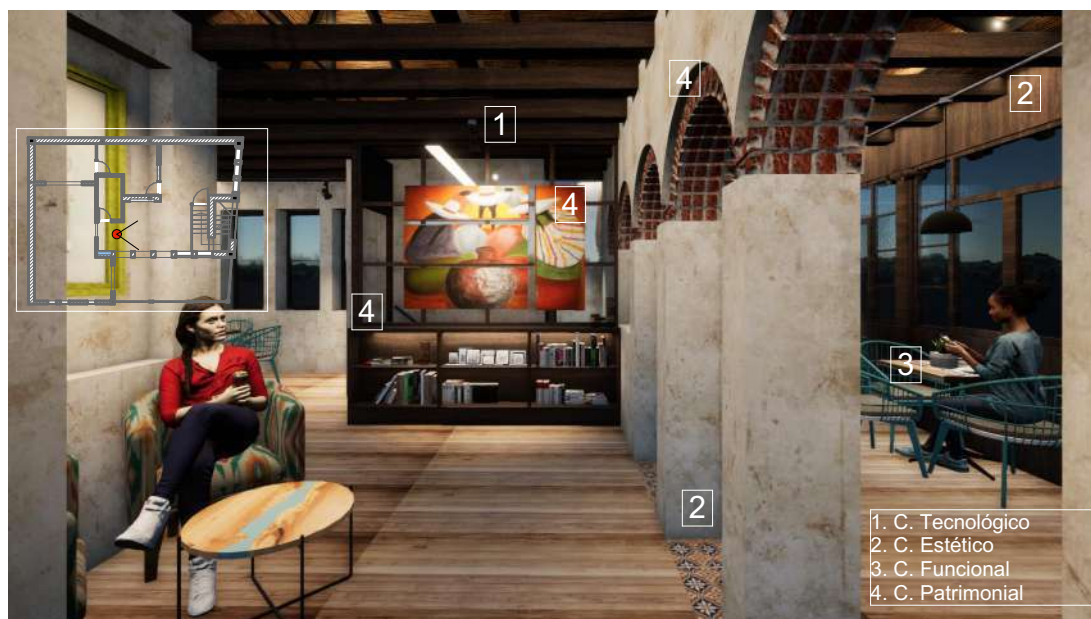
Perspectiva Interior, planta alta Cafetería – Heladería, vista desde zona de mesas hacia patio de iluminación y ventilación, Vivienda Seminario de Gualaceo / Autor, 2023.
